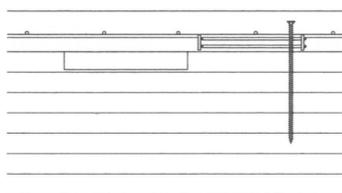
Detalles de armado de hormigón y conexión del bloque híbrido (Sauer, 2015)
